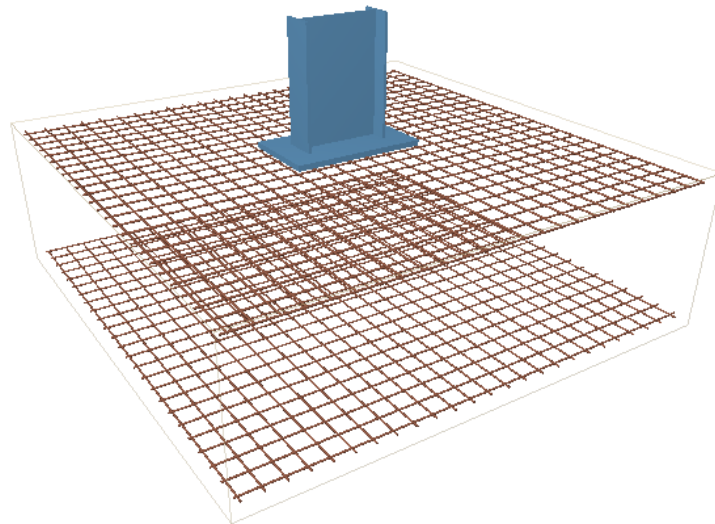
Disposición de armaduras de la zapata del pórtico de fachada.
